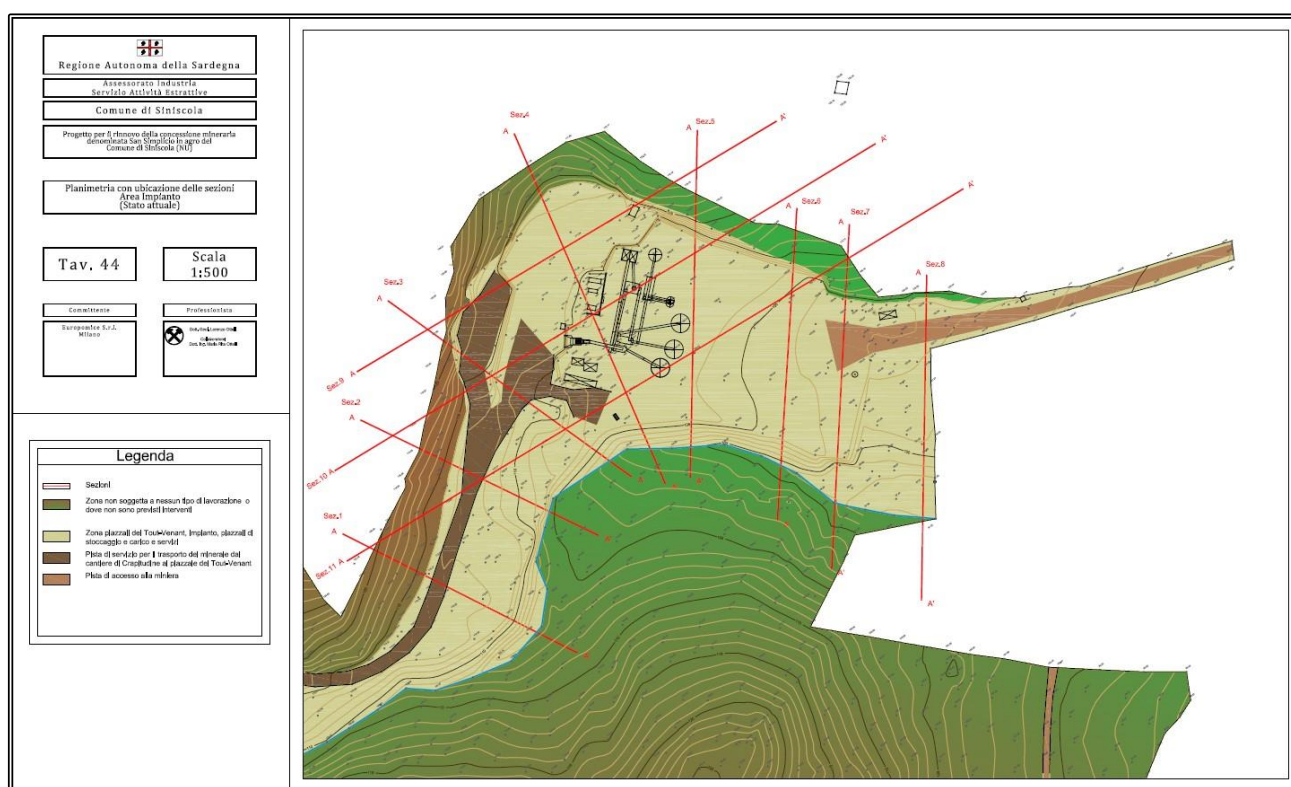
Planimetria dell'area dell'Impianto così come allo stato attuale.
